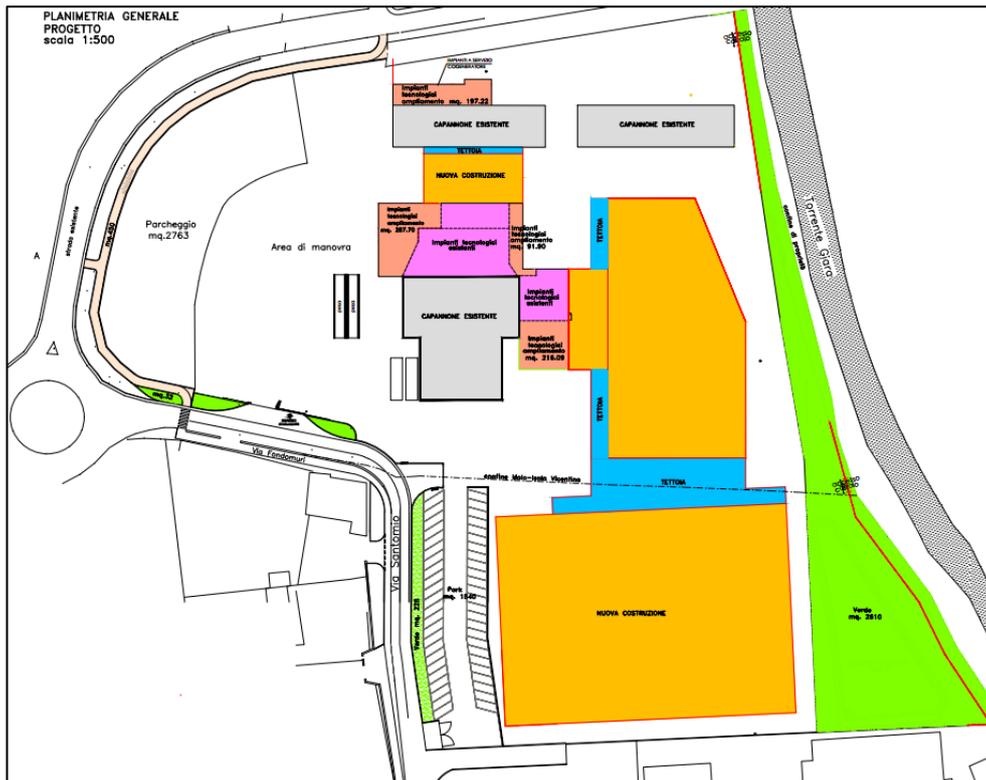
PLANIMETRIA DI PROGETTO
